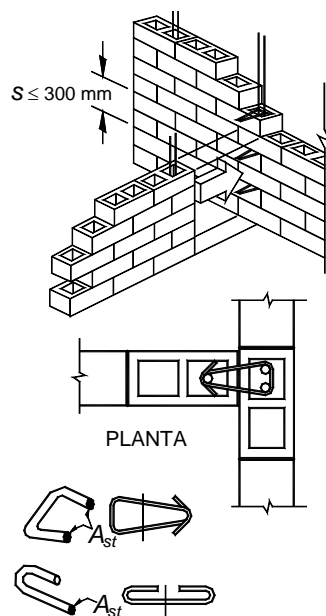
Conectores entre muros sin traslape de piezas (NTCM, 2004)
